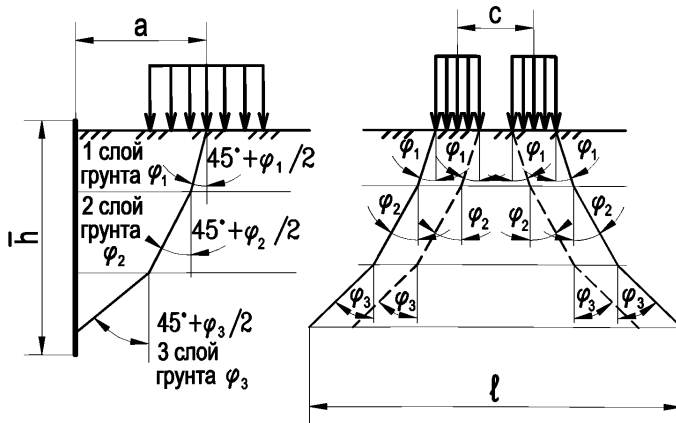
К определению эквивалентной нагрузки при наличии за стенкой нескольких слоев грунта, отличающихся углами внутреннего трения
